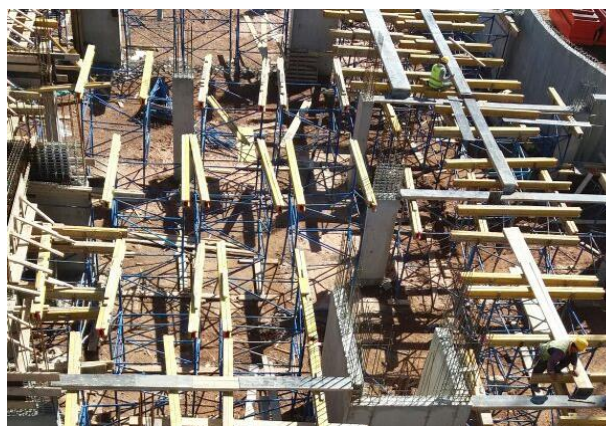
COFFRAGE D'UN PLANCHER EN PREDALLES SUR M AVENUE
